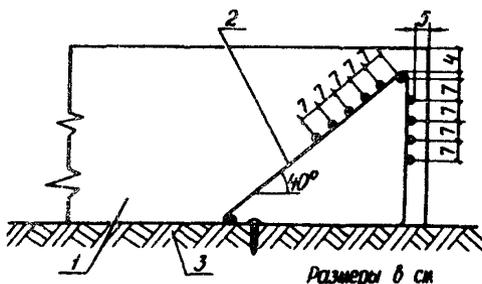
Технологическое армирование для строительства покрытий толщиной свыше 30 см в скользящих формах: 1-бетонная плита; 2-арматурный каркас; 3 - основание дорожной одежды
